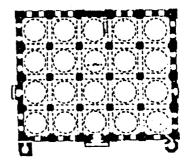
مسجد كلبرجا الجامع ٧٦٩هـ/١٣٦٧م (سلاطين بهمن) : مسقط أفقي .
